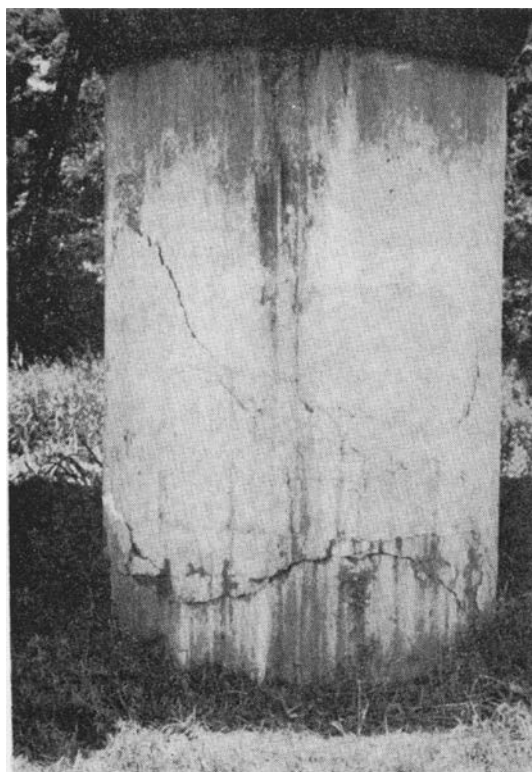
閑上大橋のP1橋脚の斜めひび割れと水平ひび割れ
